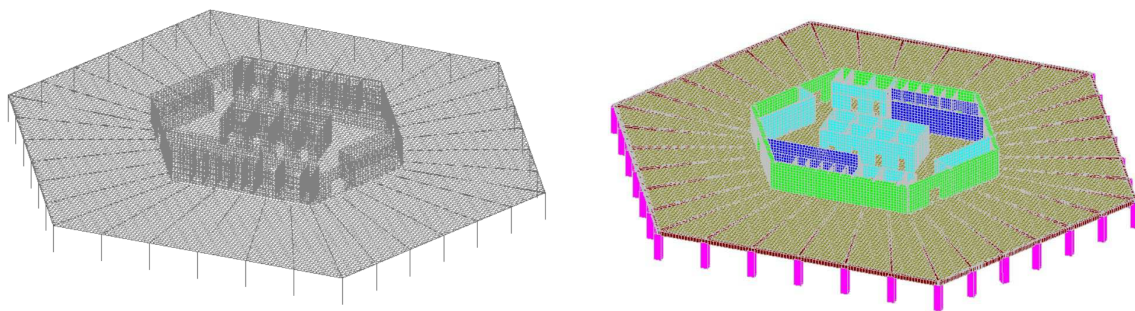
Расчетная схема плиты перекрытия по балкам.
